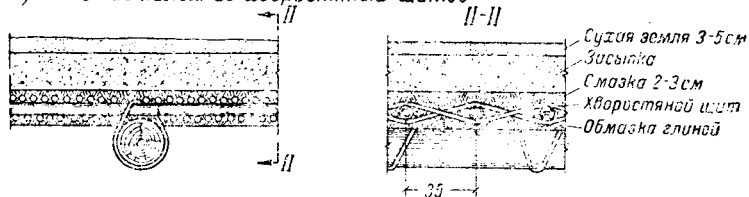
Чердачные перекрытия с настилом из глино-хвороста
